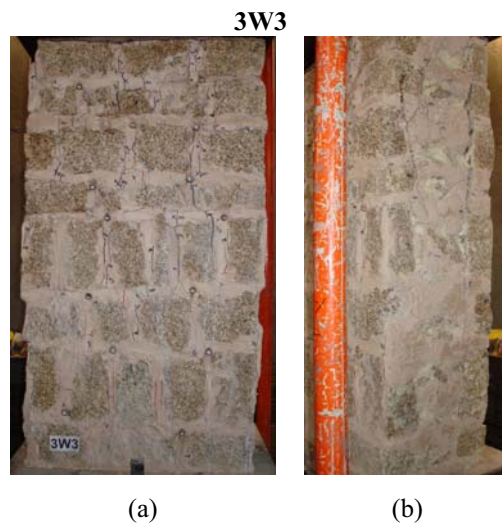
Padrão de fendilhação da parede 3W3 no final do ensaio: (a) face B; (b) face C.
